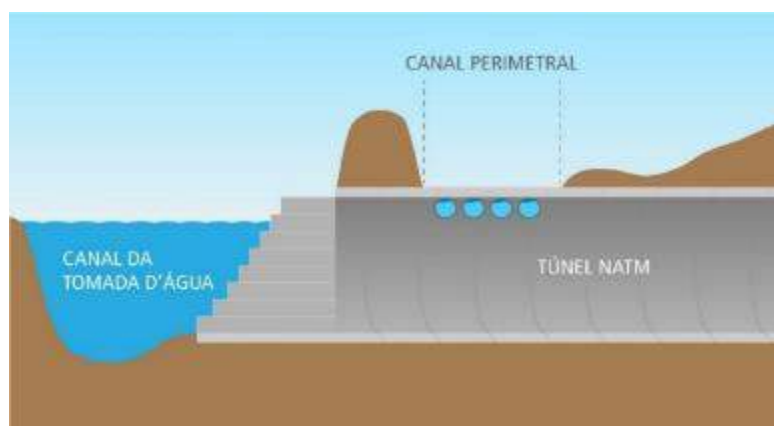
Caso 10 – Travessia do canal Perimetral – Posição dos tubos na seção do túnel
